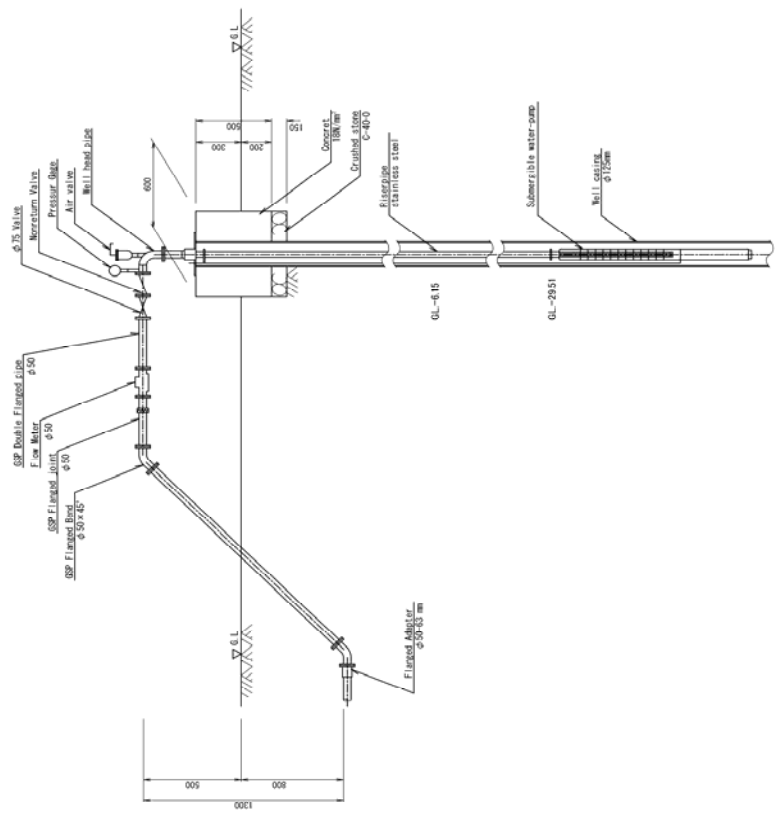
レベル2 給水施設配置図 (J-II-9 Zangasso)
